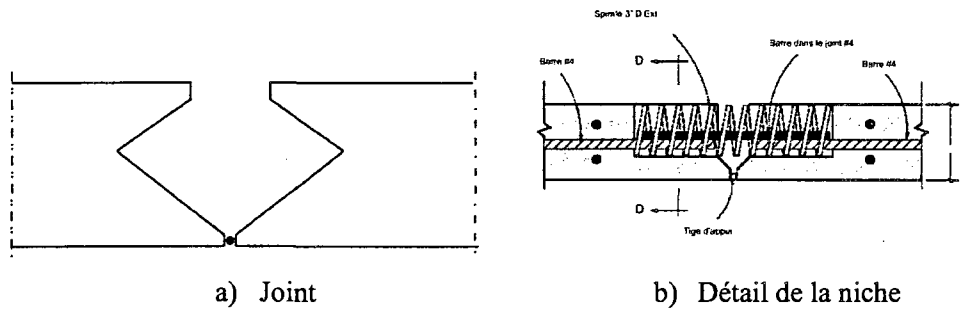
Joint et détails entre les pré-dalles du système NUDECK [Adaptée de (Badie 1997)]
